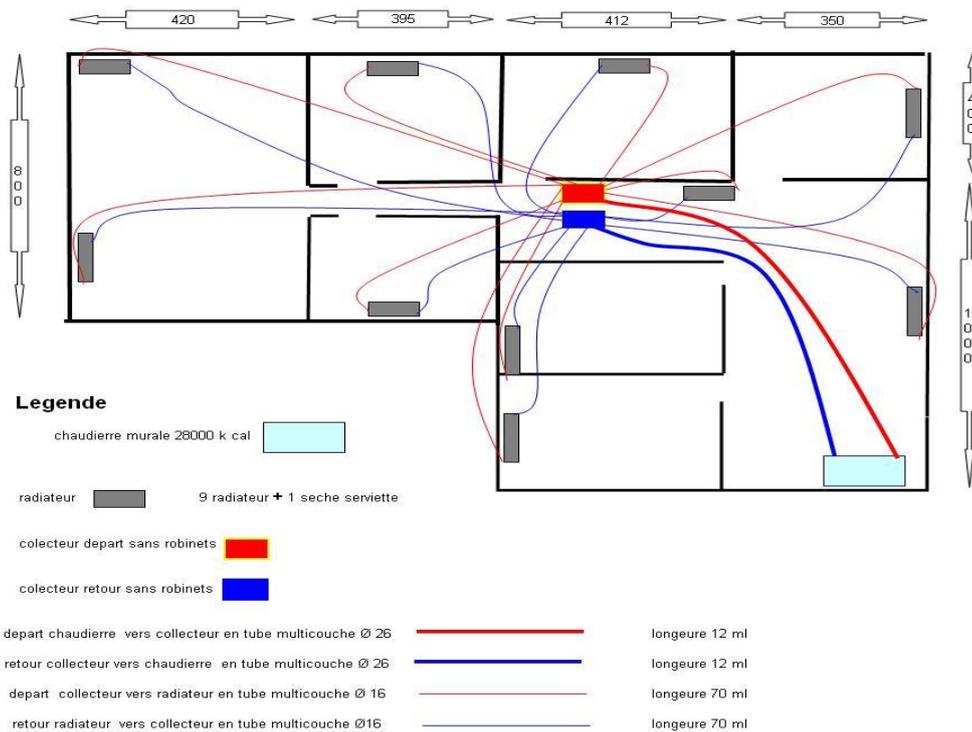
Exemple d'une représentation sur plan d'un chauffage central individuel au gaz.
